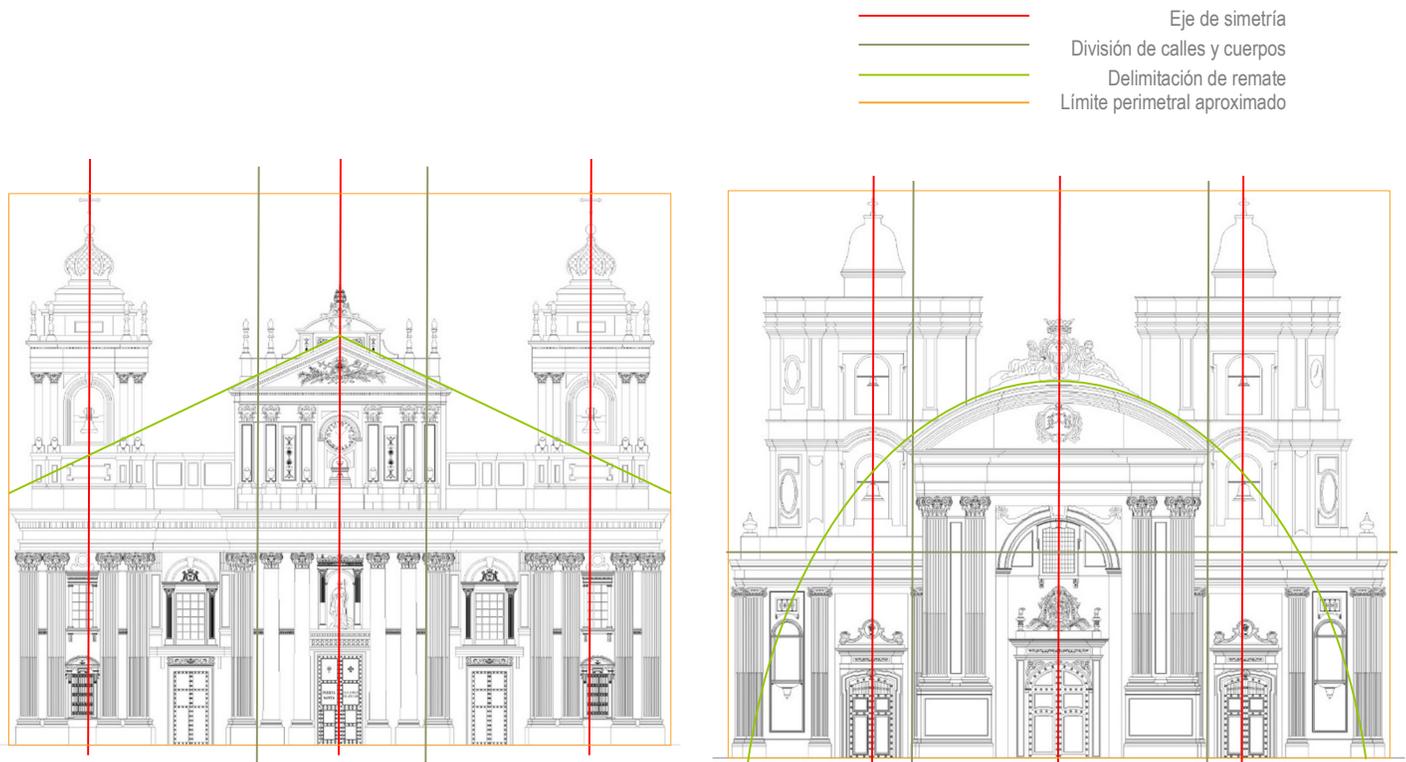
Fachada Catedral. Sin escala. Elaboración propia.
